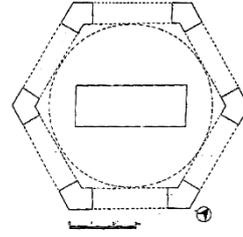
مسقط أفقي لترتبة عتيق علي باشا في استانبول عن:
